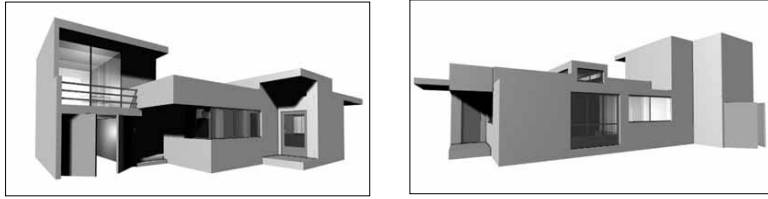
가렛 건설공법 (Garrett construction system)을 이용한 방 3개 형태의 '윈들러 셀터' 디자인
